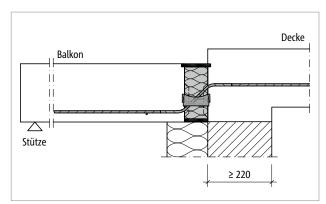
Schöck Isokorb $^{\circ}$ T Typ QL: Einbausituation mit kleinem Höhenversprung
